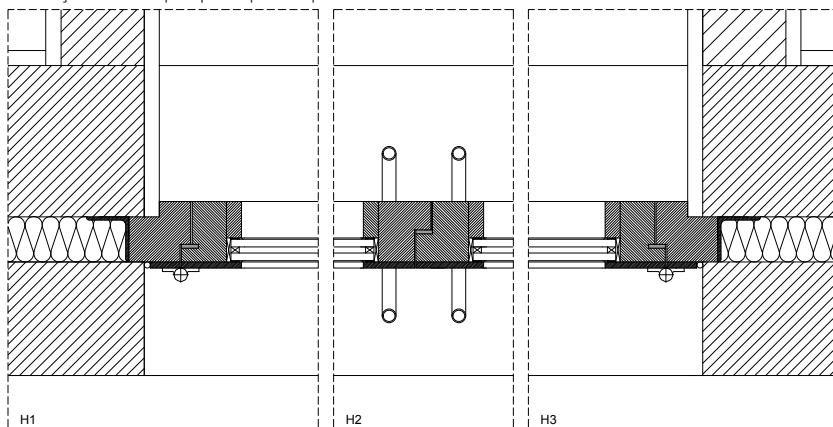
VE4 | Proposta | Planta | Escala 1.10
